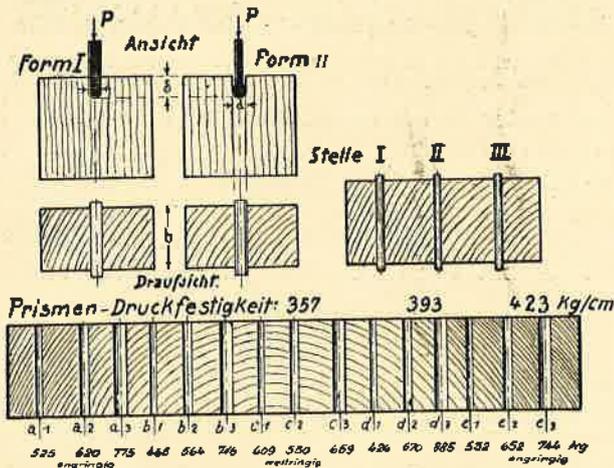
Einpreßversuch parallel der Holzfaser mit biegefesten Nägeln; die Lage der Jahresringe ist angegeben. Durchmesser 3,1 bis 6 mm.
